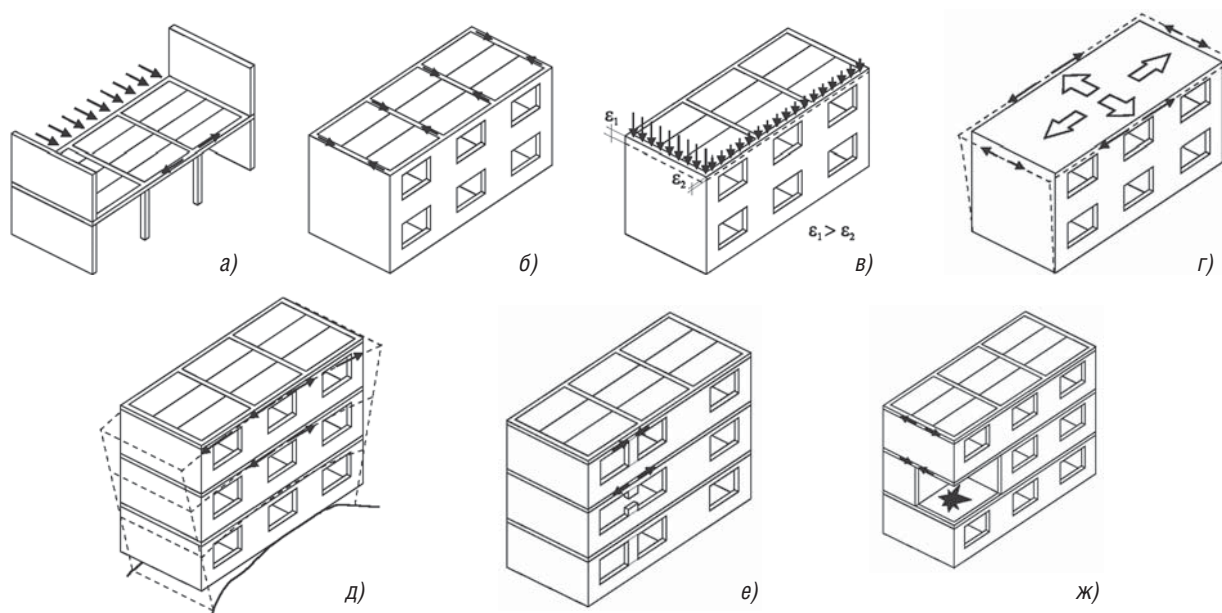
Схемы работы кольцевого анкера сборного перекрытия (стрелками обозначены направления возможных усилий и деформаций здания или его отдельных частей)
